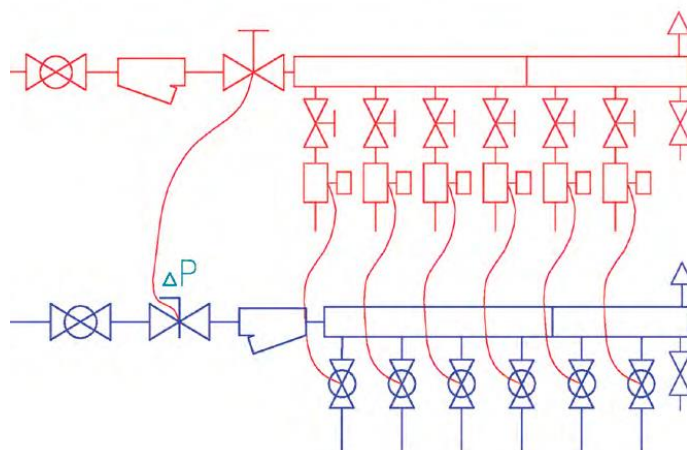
Принципиальная схема поэтажного коллектора с теплосчетчиком на подающем трубопроводе
